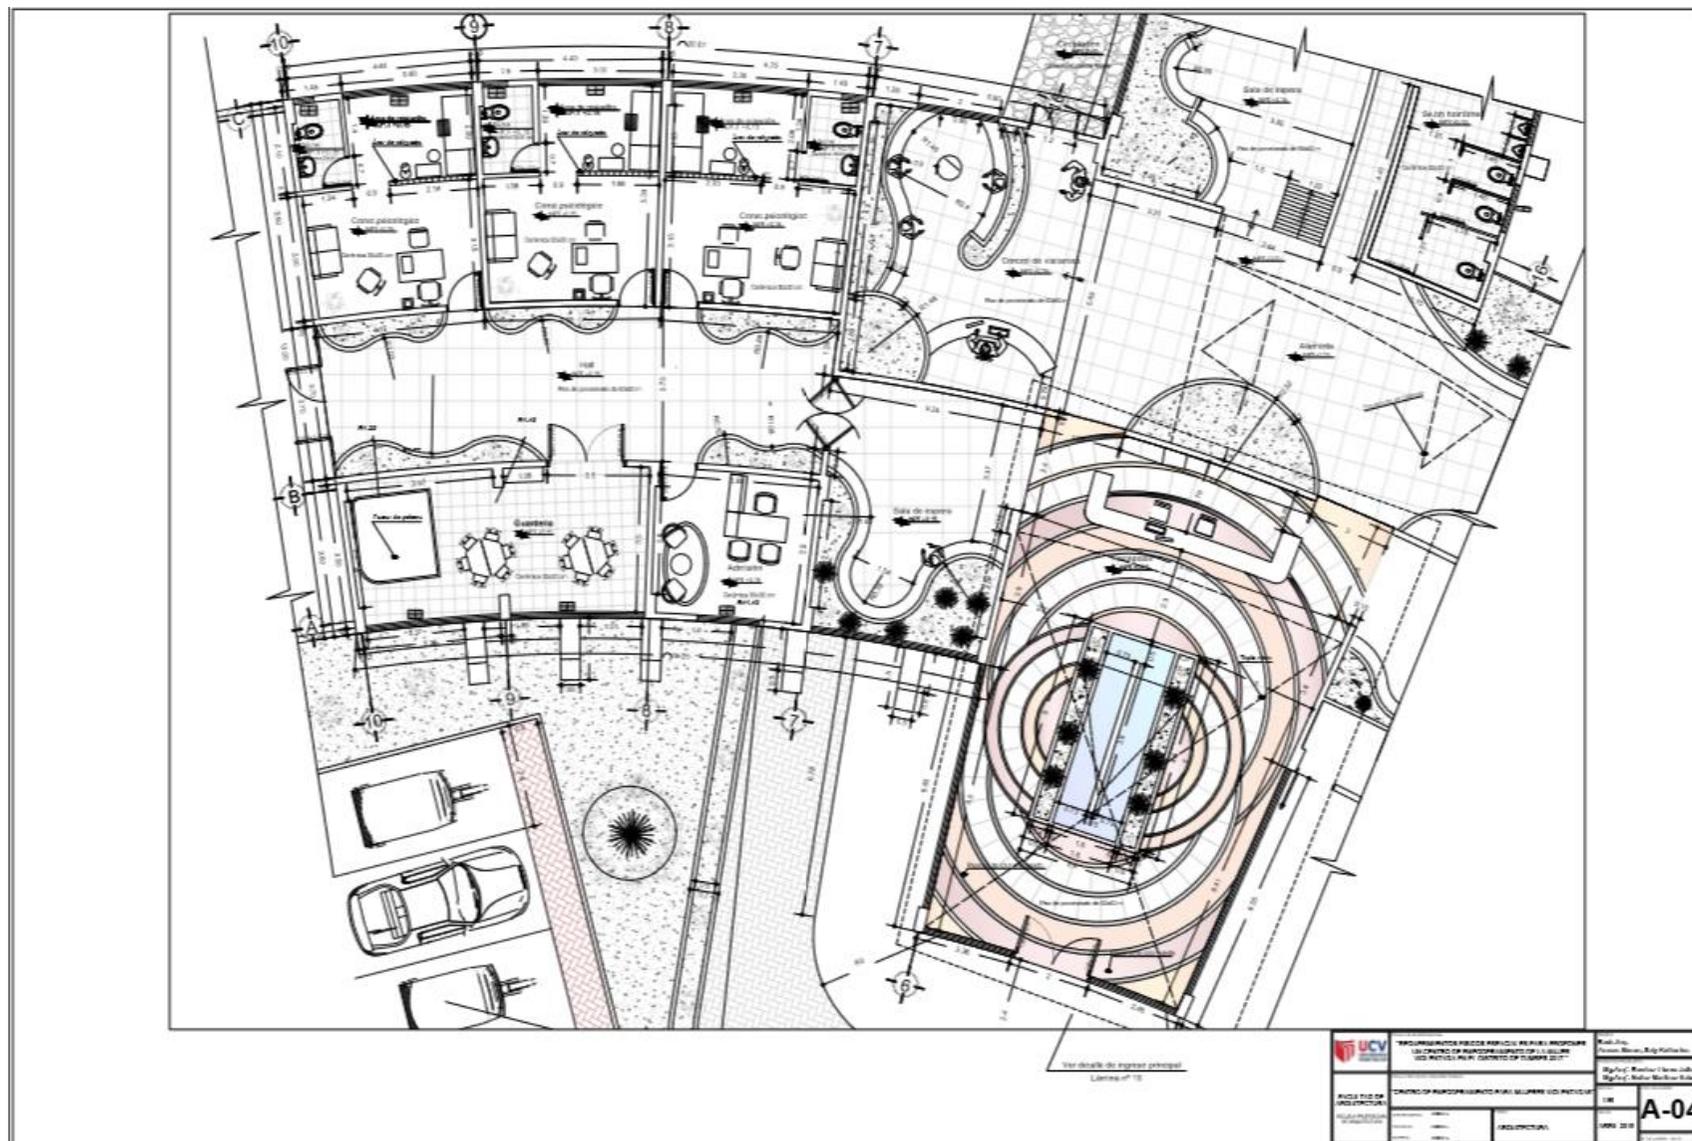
Plano de detalle constructivo – zona de atención preliminar y recepción
